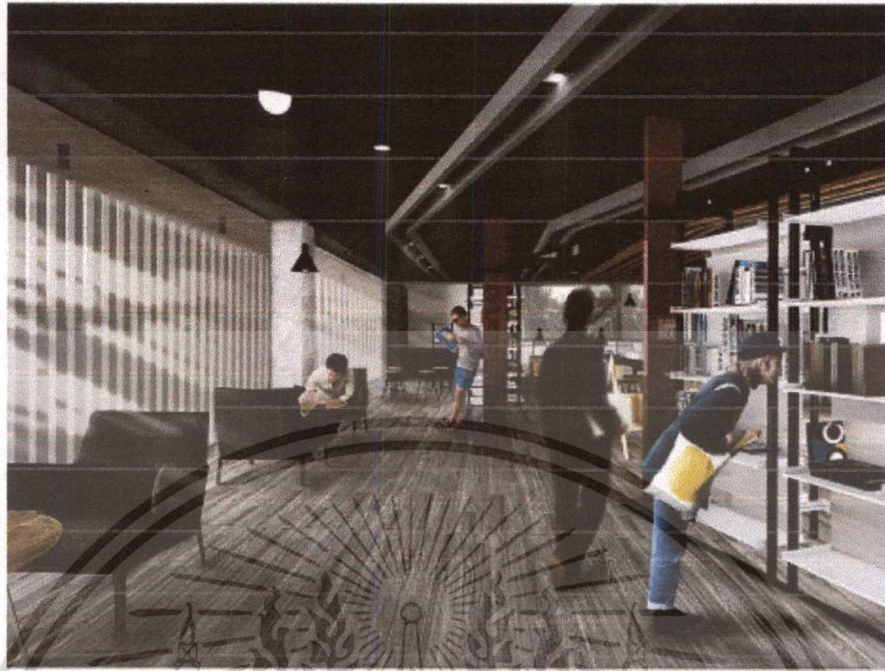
รูปแสดงทัศนียภาพ (Florey room)
